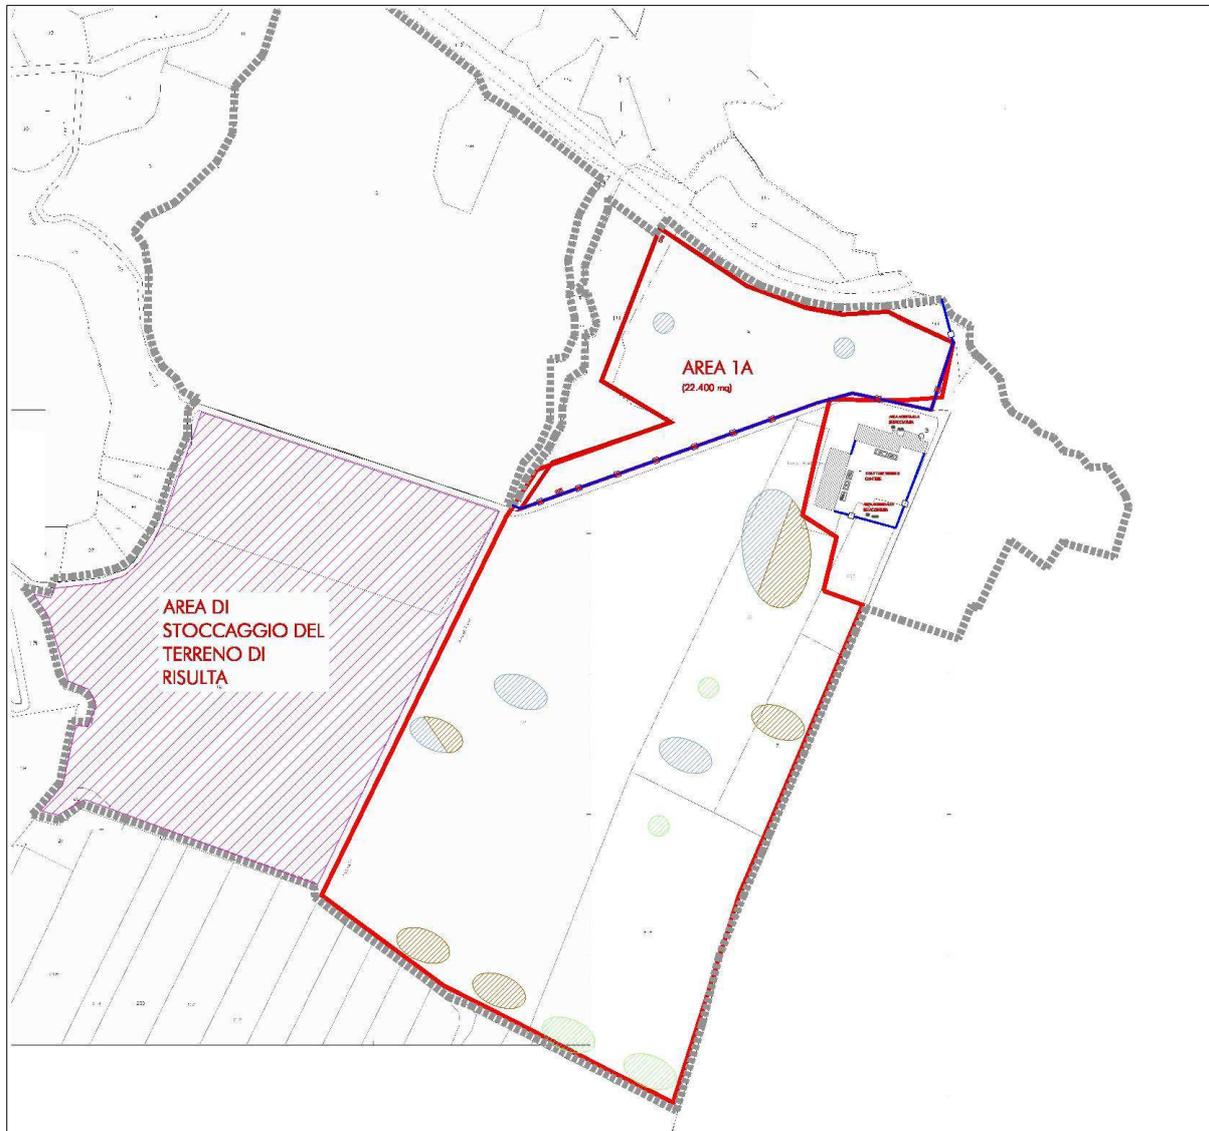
Planimetria generale della prima fase di scavo – Area 1A
